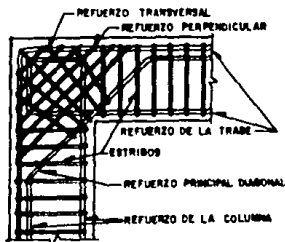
Refuerzo de confinamiento sugerido para la conexión de rodilla.
